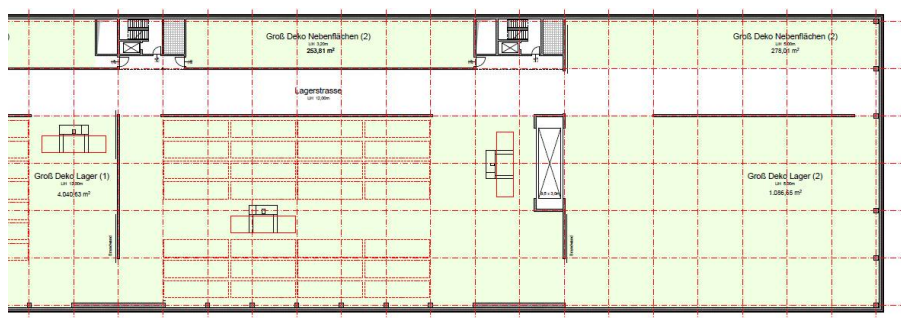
Auszug Obergeschoss mit Lagersystem (Variante Boxen)
